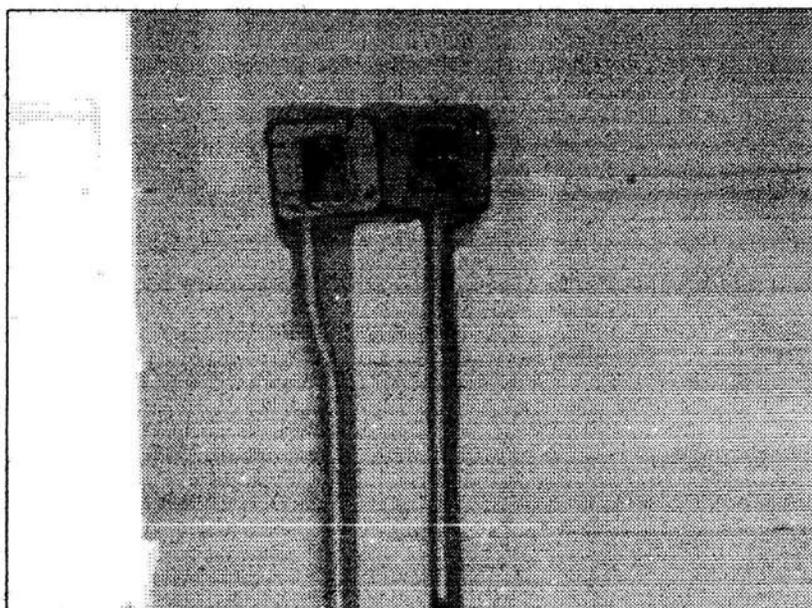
En la fotografía se muestra el aspecto de las instalaciones eléctricas embebidas en muros de bloque de concreto celular.
